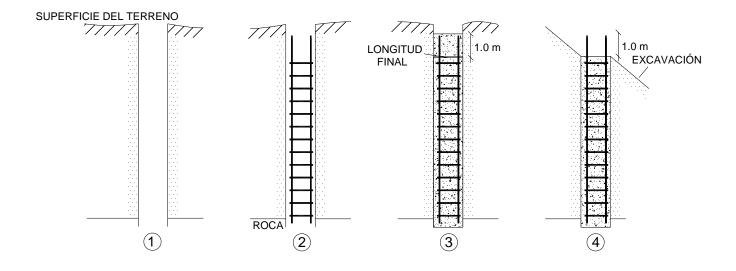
Método Constructivo de los Pilotes de Concreto
